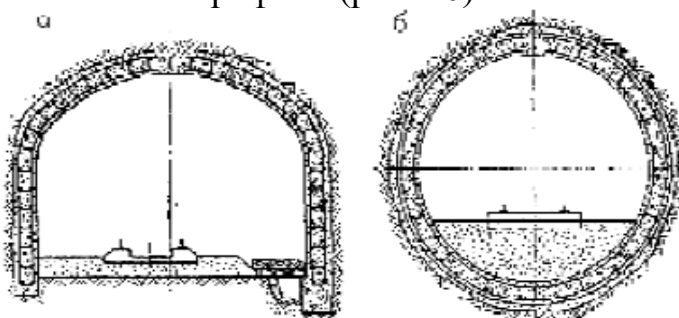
Залізобетонне кріплення з гнучкою арматурою:
